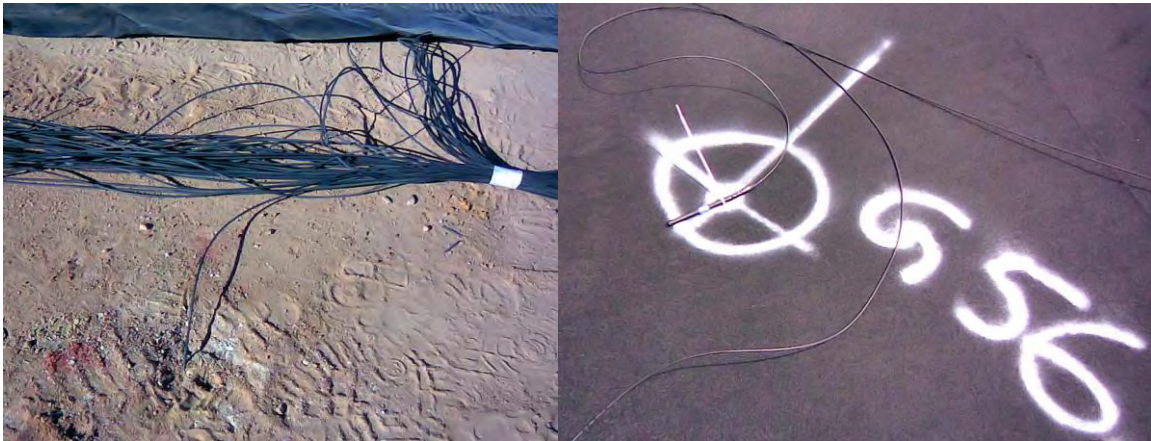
Sensores instalados em sistema simples e duplo de impermeabilização.
